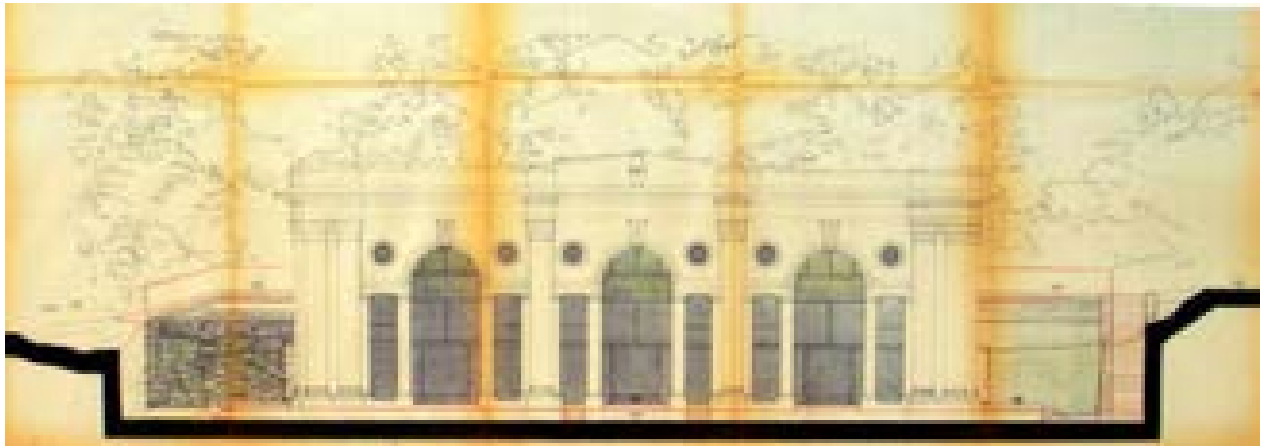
Prospetto Sud stato sovrapposto, progetto concessionato il 15/01/1985 (AABS-130)
